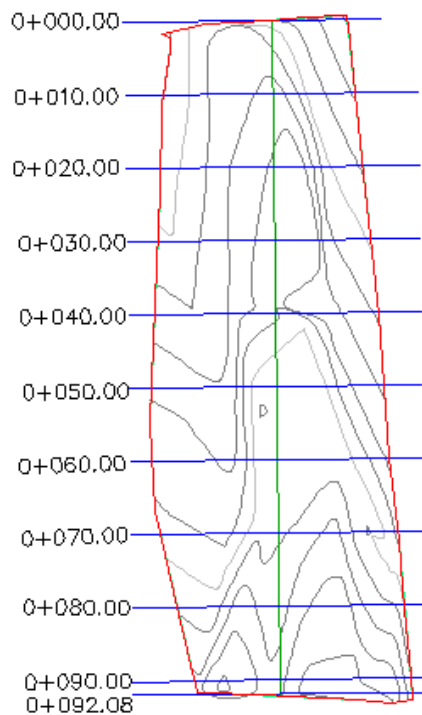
Vista en planta, tramo río pamplonita (Fuente: Autocad)
